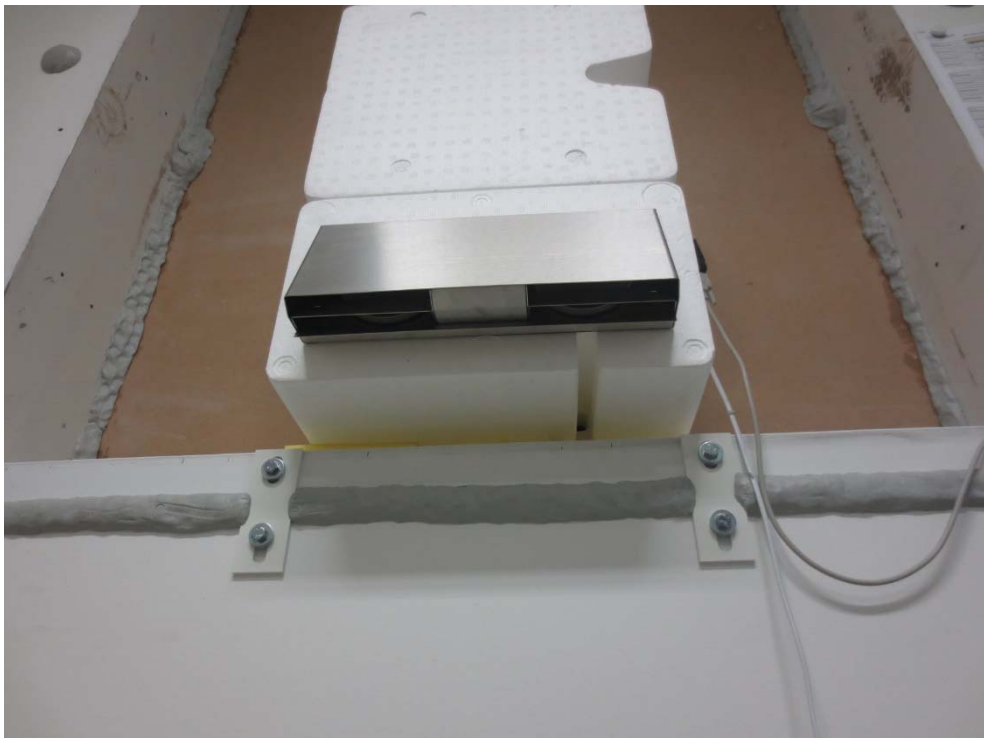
Ansicht Außenseite von schräg unten (prüffertig): Fassadenabschluss Edelstahlschote auf Mauerkasten montiert, mit Außenöffnungen (FOL links, AUL rechts).
